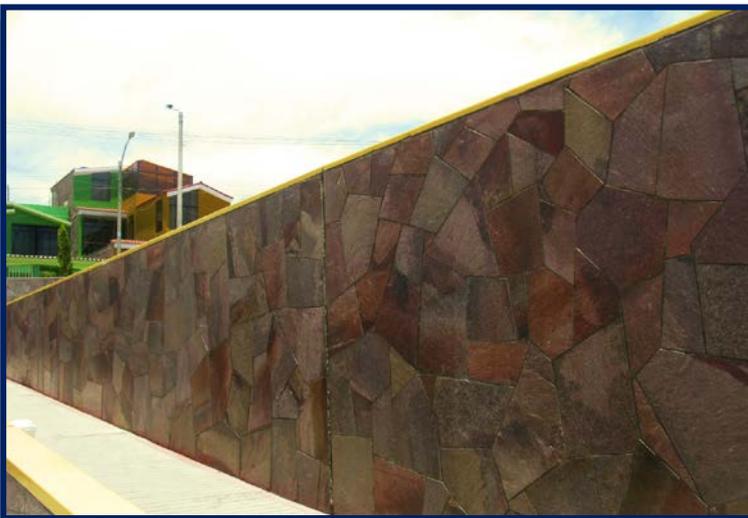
y 9: Detalle de la obra terminada. Coliseo cerrado de Moquegua.
